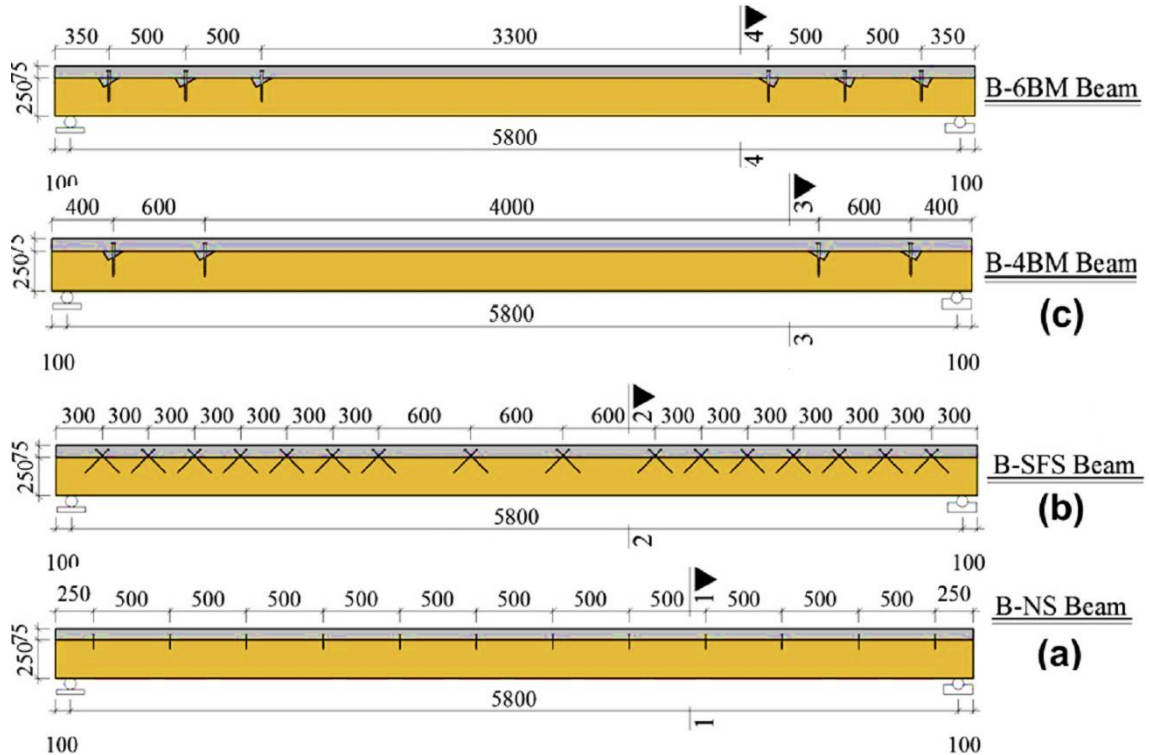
Détail des poutres mixtes avec différents connecteurs : (a) NS (b) SFS (c) BM [26].
